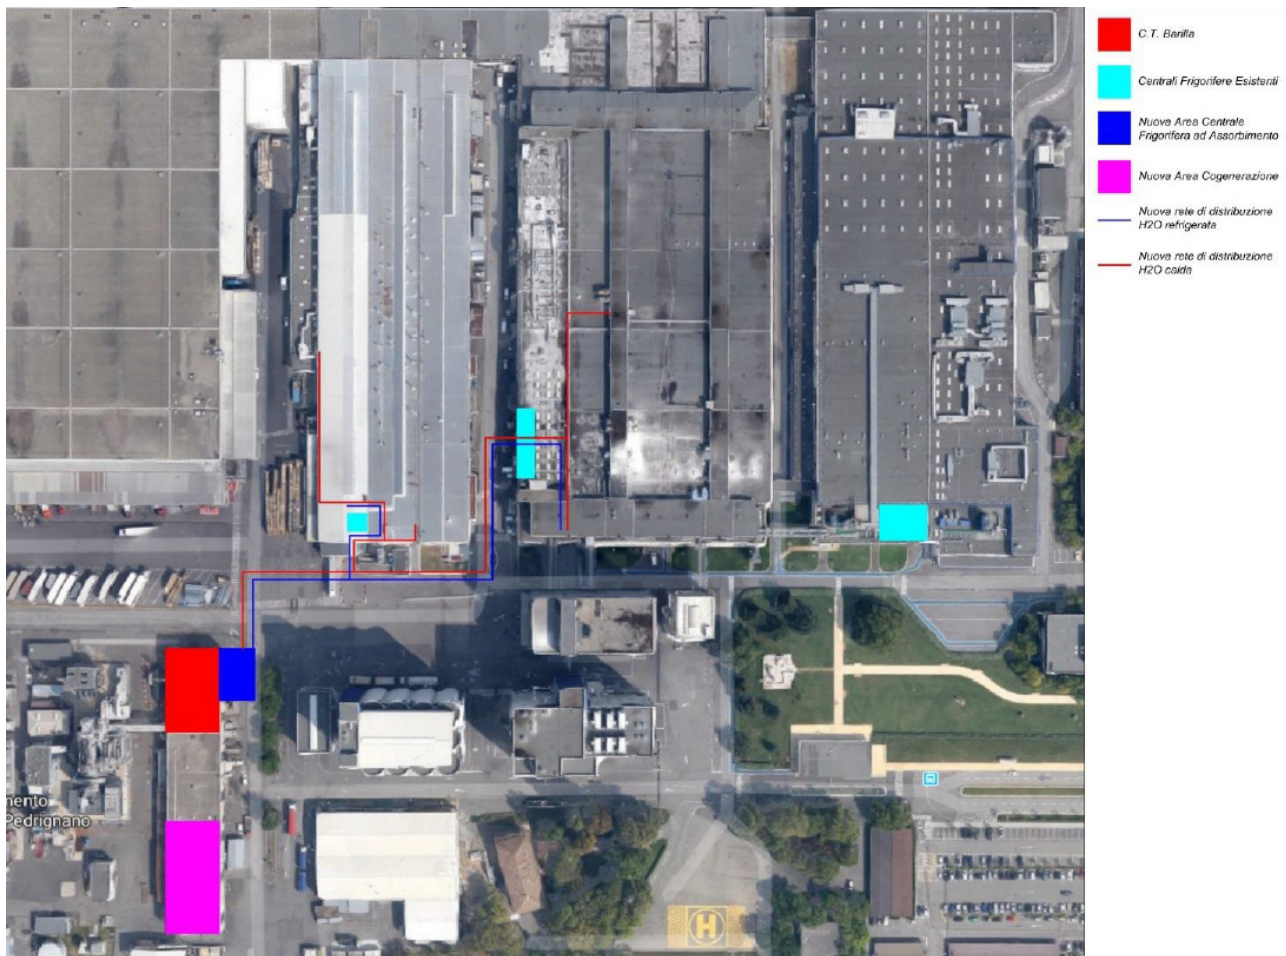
Futuro assetto impiantistico di progetto – Ubicazione delle centrali energetiche e tracciati piping di interconnessione
